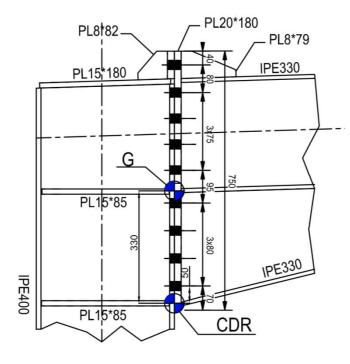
Vue de détail de la liaison Poteau-Traverse de la file 2 côté B. La liaison est un encastrement par platine d'about (PL20*180) vissée dans la semelle du poteau (IPE 400). Deux rangées de 9 boulons (M24 de classe 4.8) assurent la transmission des efforts. Les trous de perçage sont normaux. On a indiqué la position du boulon le plus sollicité au-dessus des semelles de la traverse (bl n°1). Notez que le CDR (centre de rotation) est placé au niveau de la semelle inférieure du jarret à 50 mm de la plus basse ligne de boulons.
